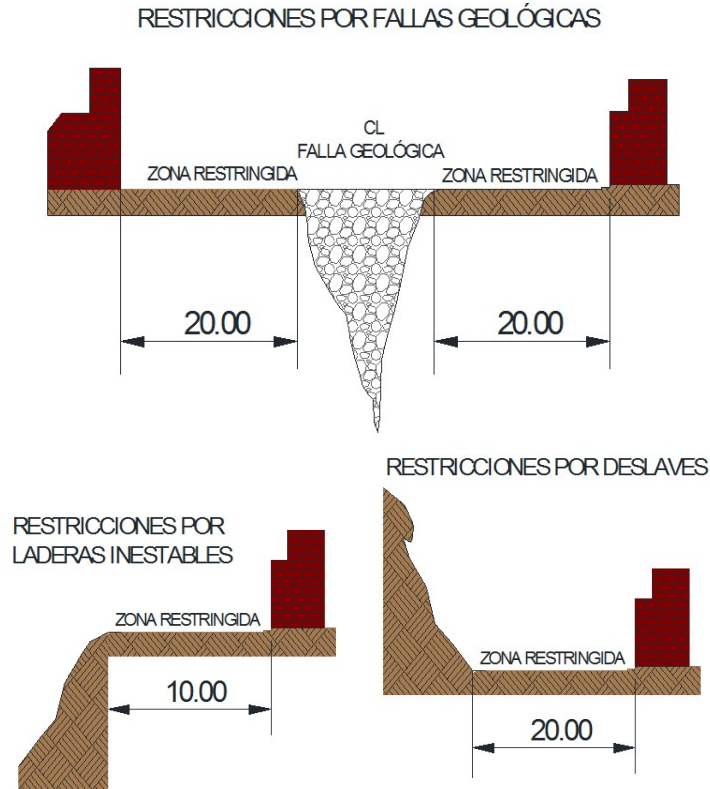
Restricciones por fallas geológicas, laderas y deslaves
